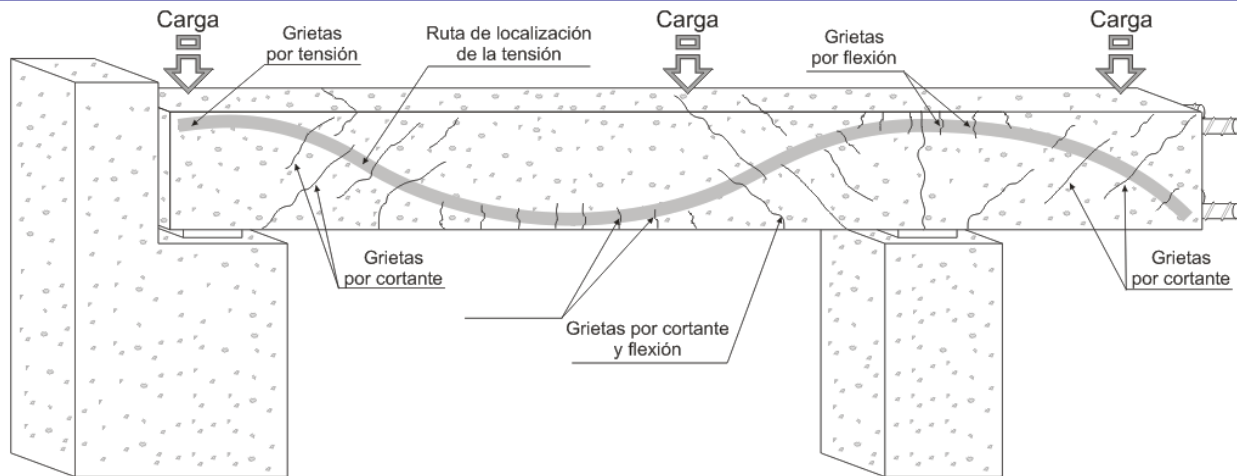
Grietas por cortante, flexión y tracción a lo largo de un viga simplemente apoyada con restricción lateral en un apoyo.
